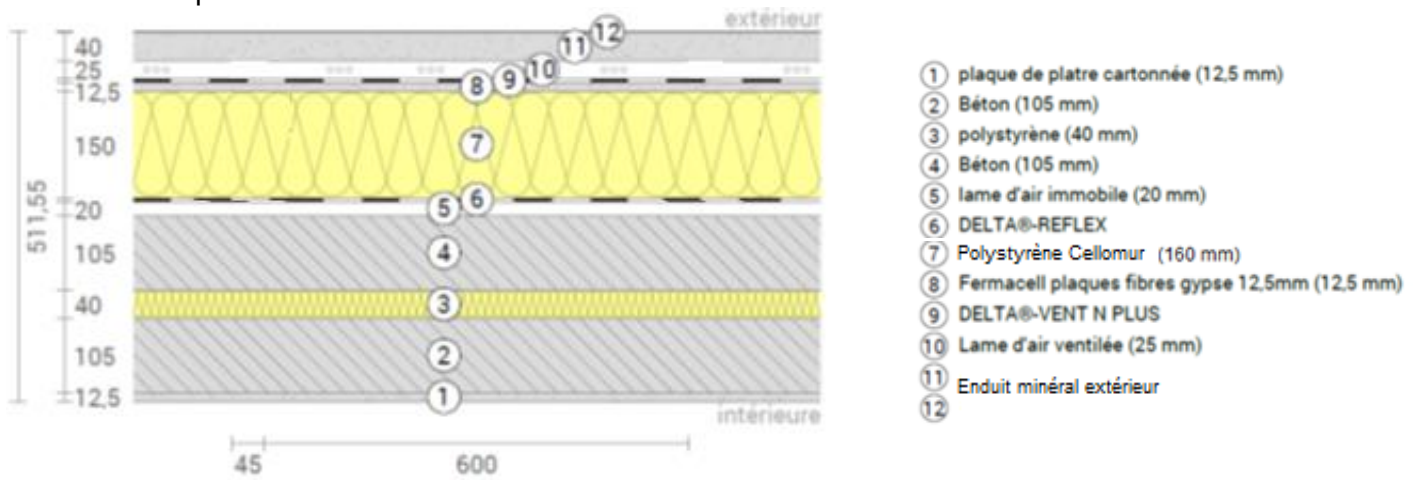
Plan en coupe du Modèle 3 proposé en ITE
